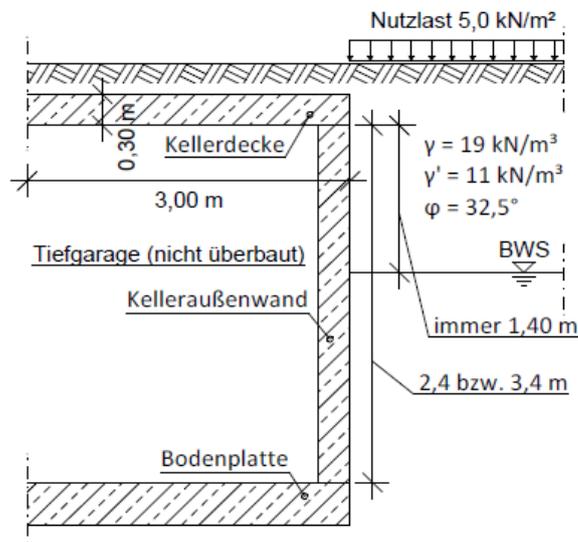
Gebäudekonfiguration: Lastfall 1 (= LF 1) [HÜB16]
